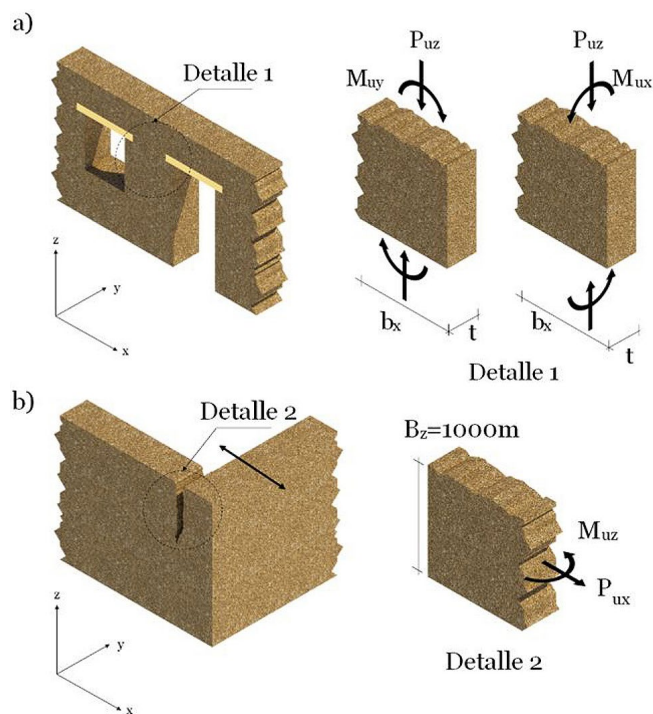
Convención y direcciones de las acciones externas sobre los muros en tierra. a) Muro en tierra y detalle 1 con fuerzas internas b) Esquina del muro en tierra y detalle 2 con fuerzas internas.
